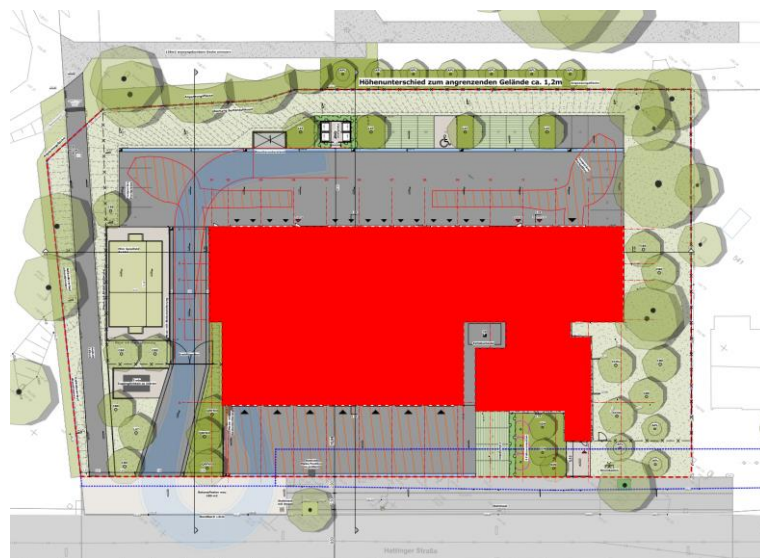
Auszug Lageplan Architektur (Nordausrichtung)
